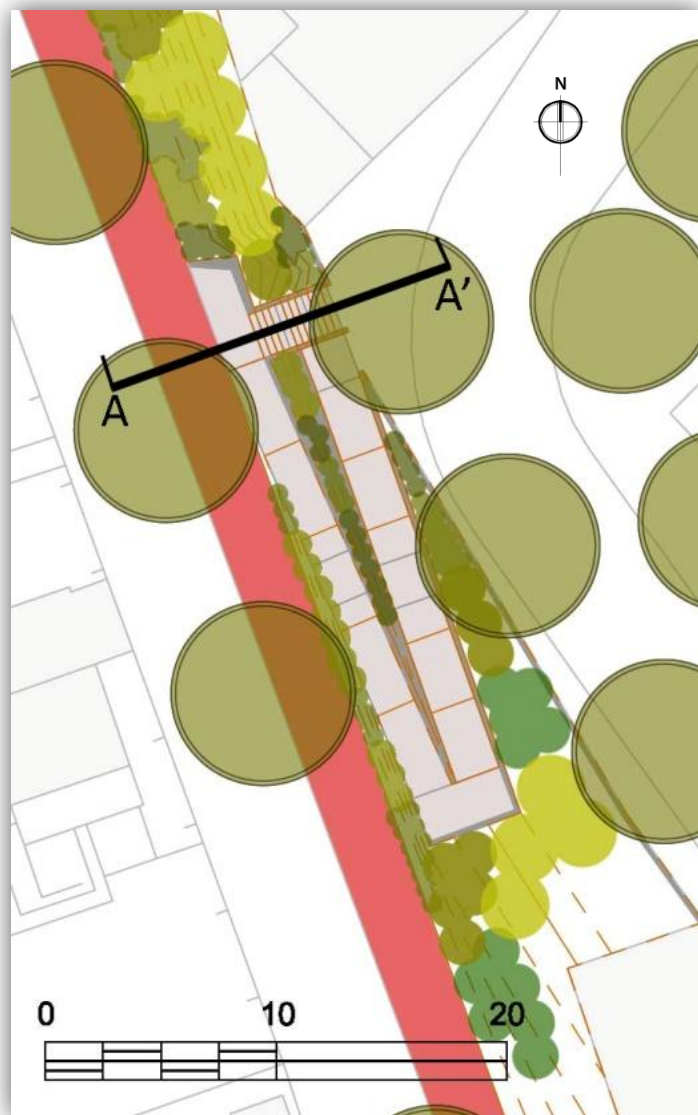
Planta da proposta para o acesso existente no Bairro de Nossa Senhora da Saúde e com a localização do Corte-alçado A-A'
